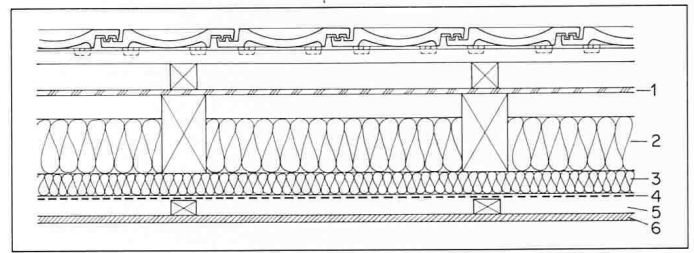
Zusätzlich verlegte Wärmedämmschicht unter den Sparren und separate Luftdichtigkeitsschicht. 1 Unterdach, 2 Wärmedämmschicht, 3 zusätzliche Wärmedämmschicht, 4 Luftdichtigkeitsschicht, 5 Installationsraum, 6 Deckenverkleidung
